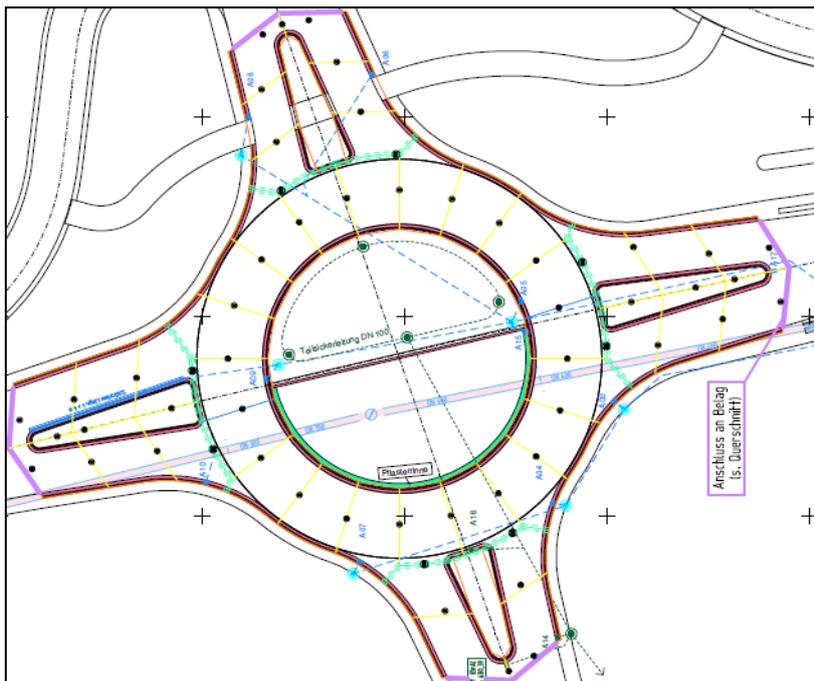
Grundriss Kreisverkehr mit Lage der Fugen (gelb markiert)
